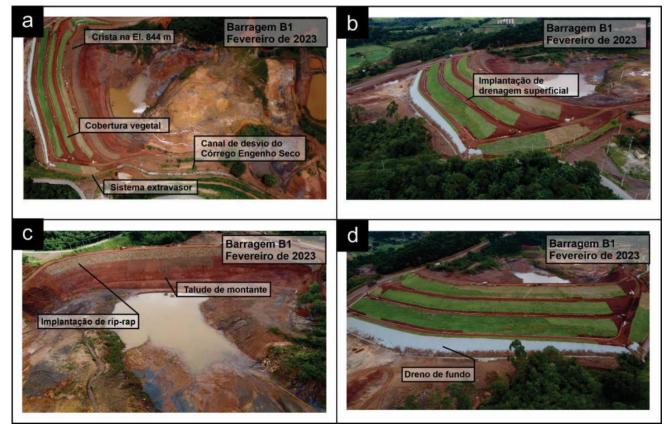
a) Detalhe para o canal de desvio do Córrego Engenho Seco; crista na elevação final de projeto; implantação da proteção dos taludes e revestimento das bermas; b) detalhe para a implantação de drenagem superficial; c) detalhe para a implantação de rip-rap; d) detalhe para o dreno de fundo.
